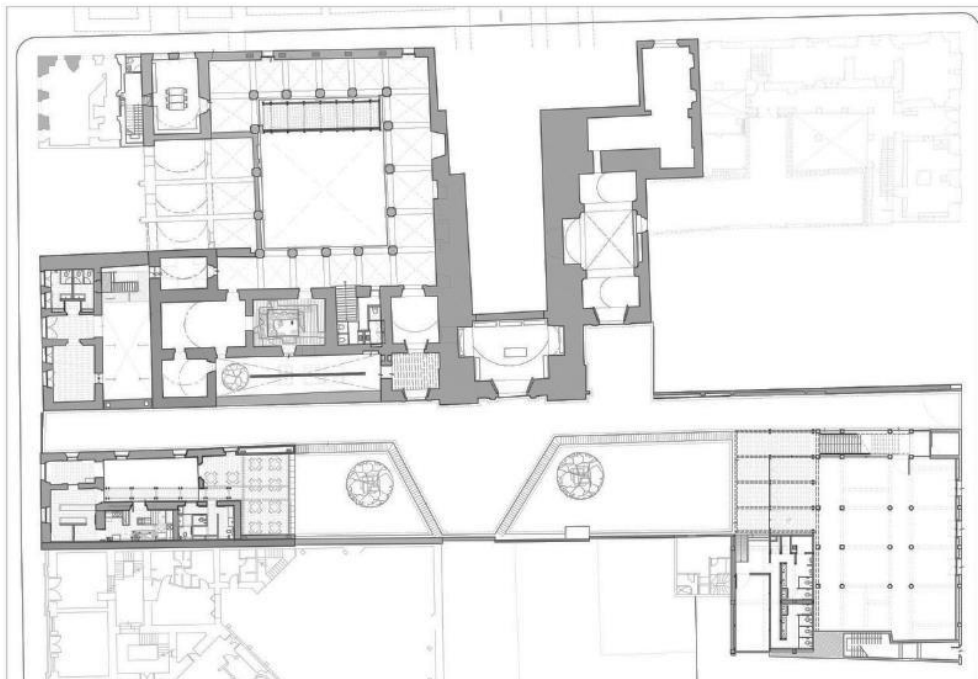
Planta Baja (Centro Académico y Cultural San Pablo) | Fuente: ArchDaily
